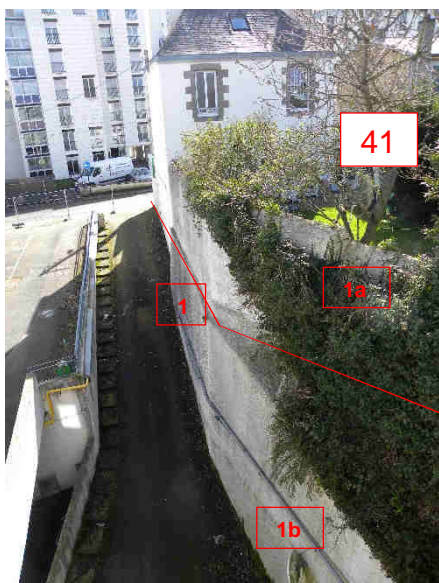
Mur N°1 – Vue depuis le Nord (terrasse)
